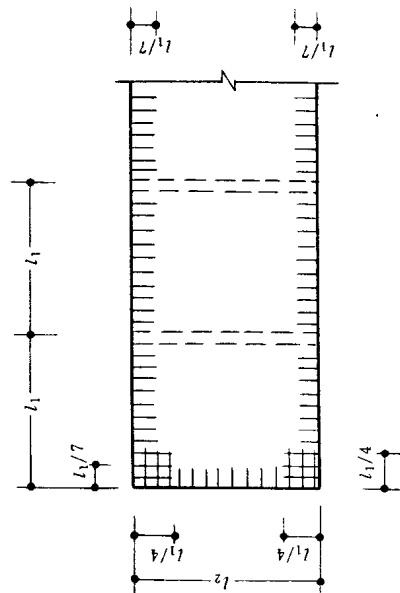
板嵌固在承重砖墙内时板边构造钢筋配筋
